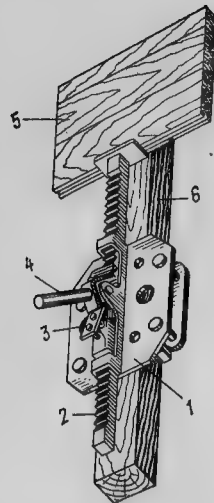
1 — устройство поджимное зубчатое двухэксцентриковое; 2 — рейка с упором зубчатая; 3 — «собачки»; 4 — рукоятка; 5 — доски; 6 — лаги
